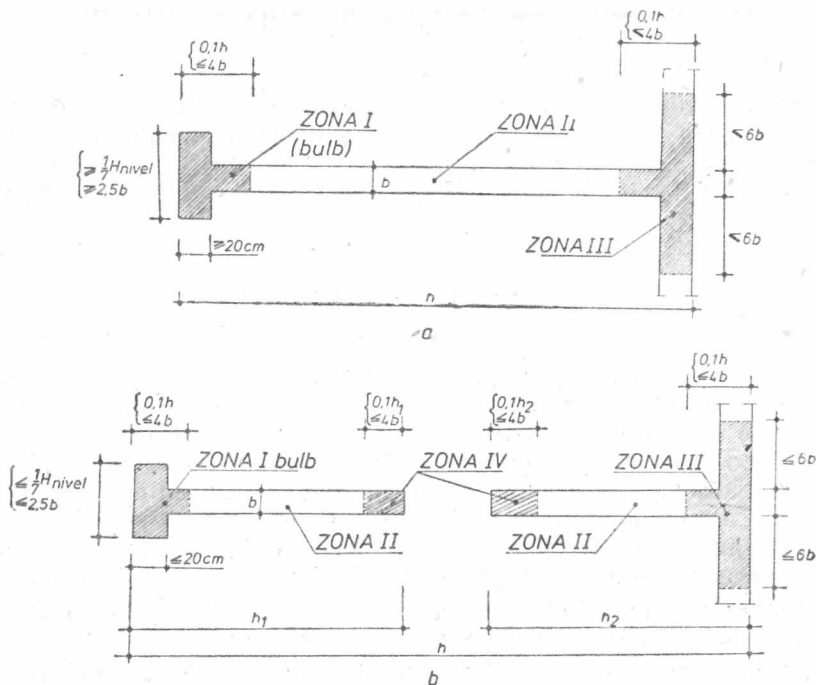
Alcătuirea constructivă a diaframelor verticale :
